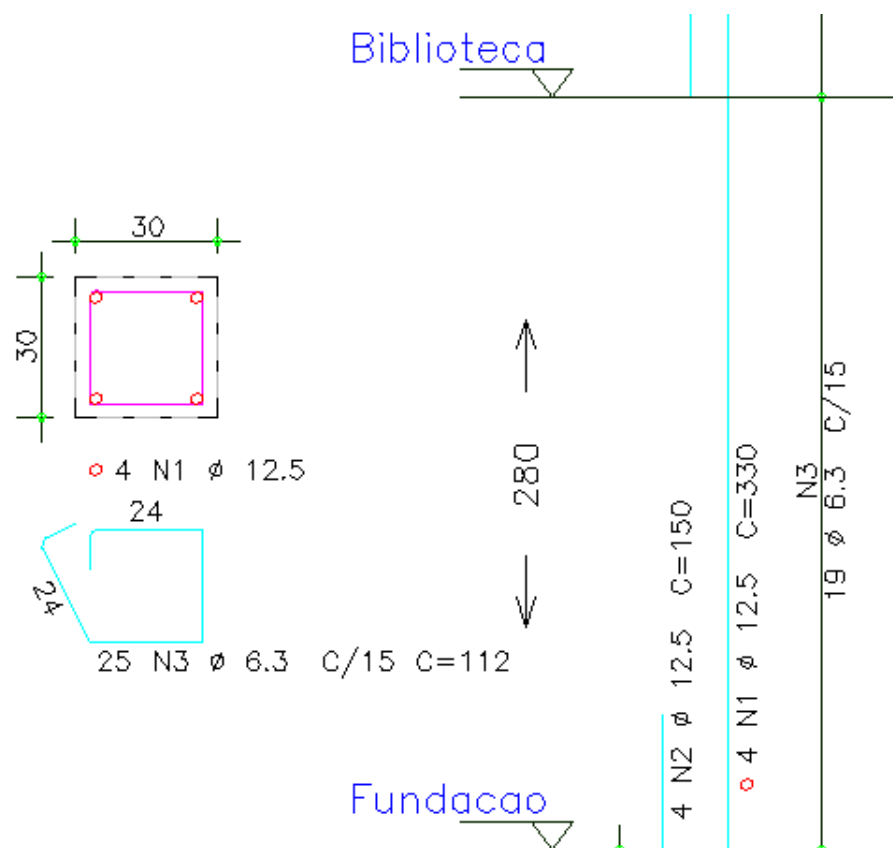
Armaduras do pilar P37 da Solução Convencional
